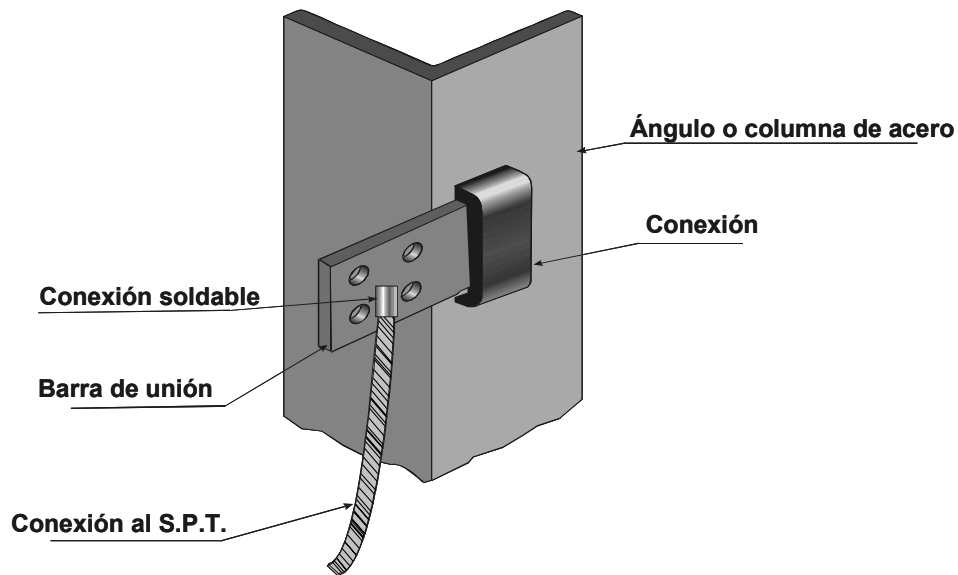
Detalle típico de conexión al acero de refuerzo (viga de acero)
